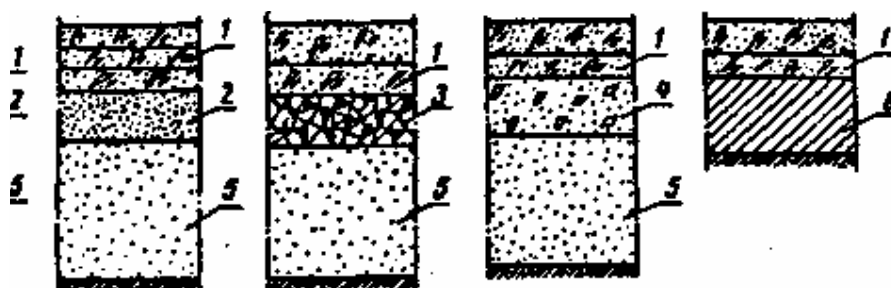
Принципиальные схемы дорожных одежд с непрерывно армированными покрытиями:
